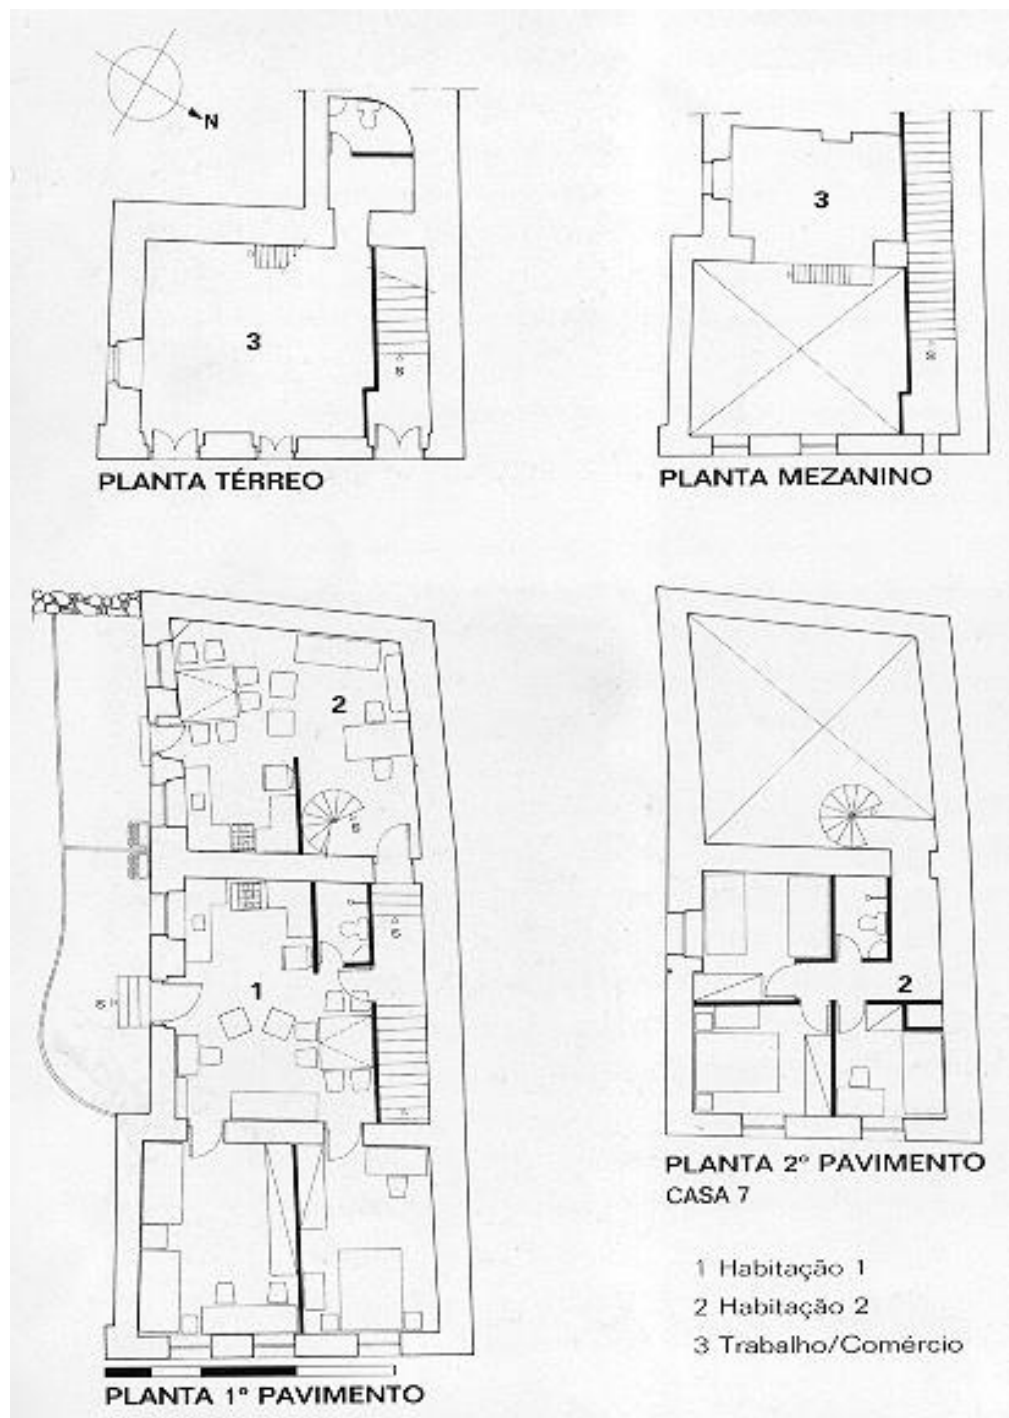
Plantas baixas do sobrado denominado Casa 07: a compartimentação interna foi executada com divisórias pré-fabricadas
